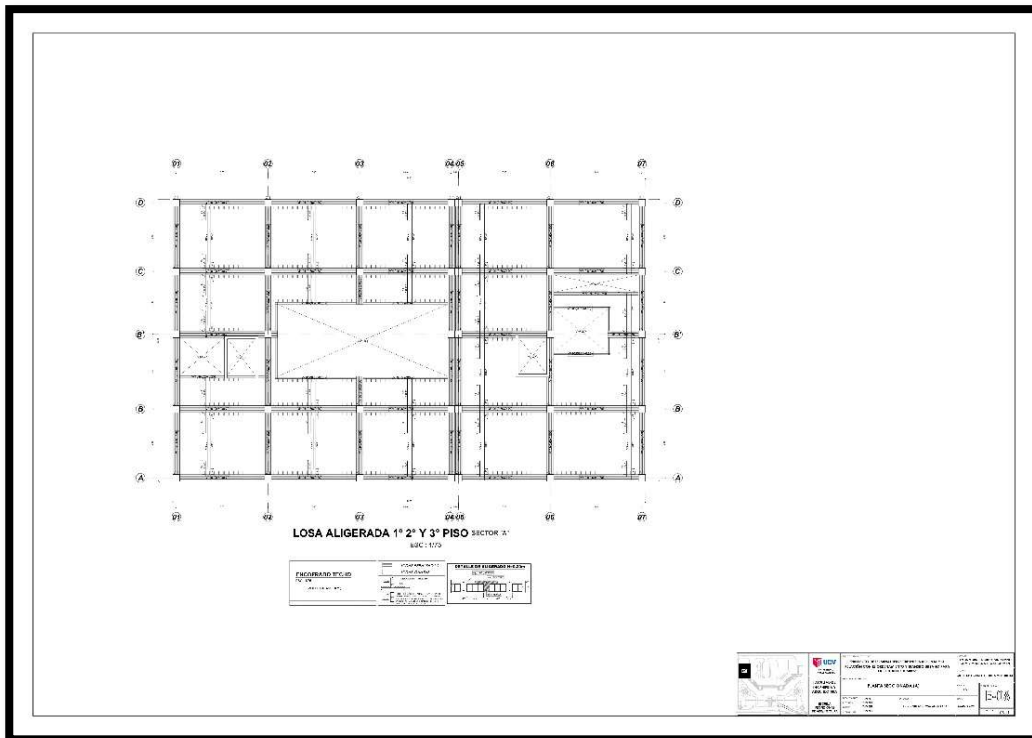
Plano de Losa Aligerada Sector (A) Fuente: Elaboración Propia.
